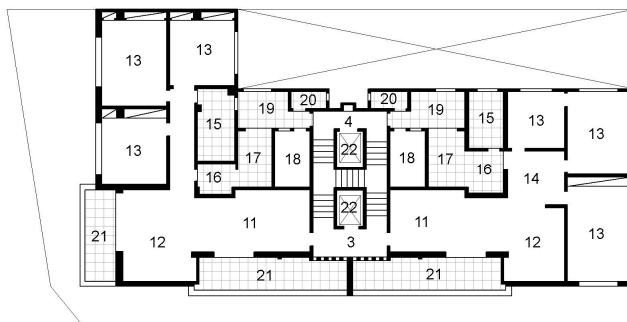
Pavto. tipo, Des: VIEIRA, M. (2008)
